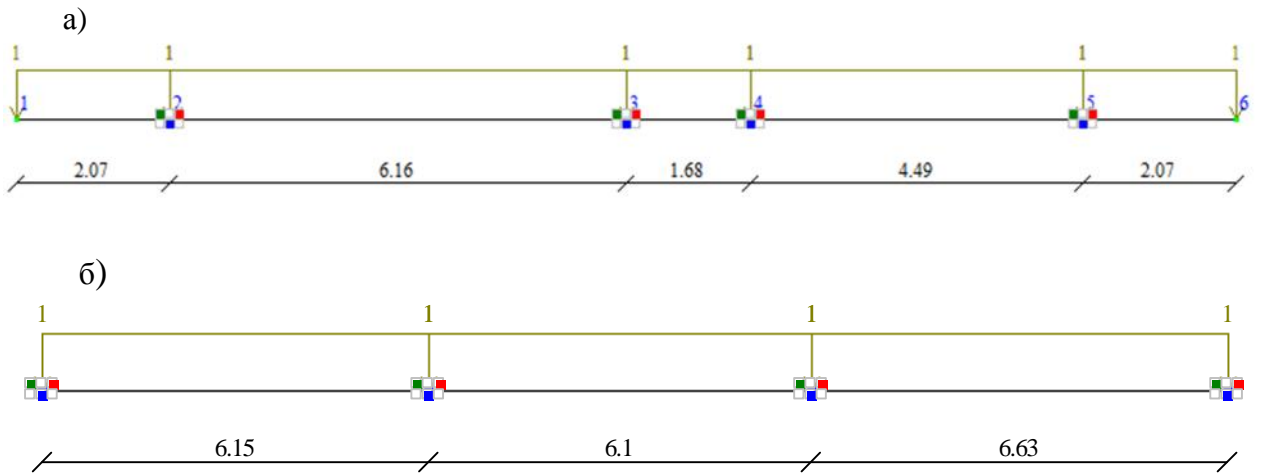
Расчетная схема балки с единичной распределенной нагрузкой:
